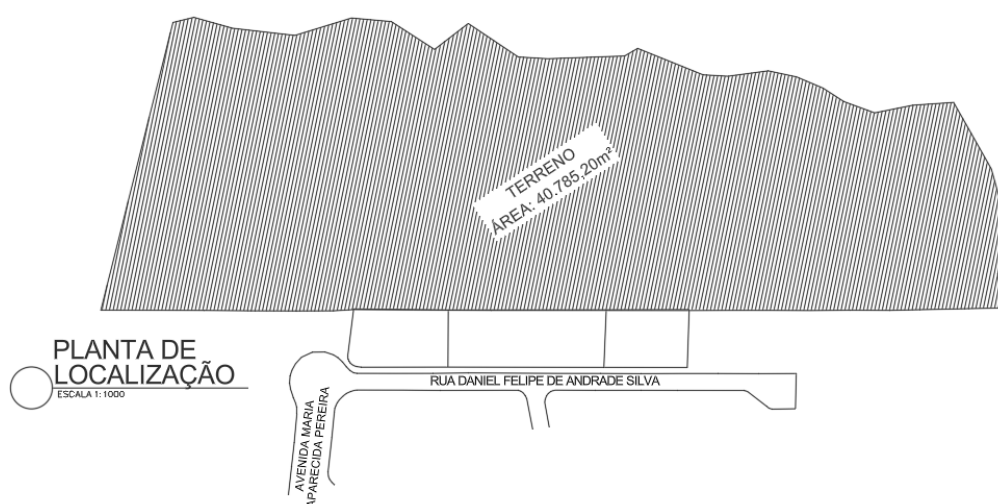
Planta de Situação. Fonte: LM5 Construtora
